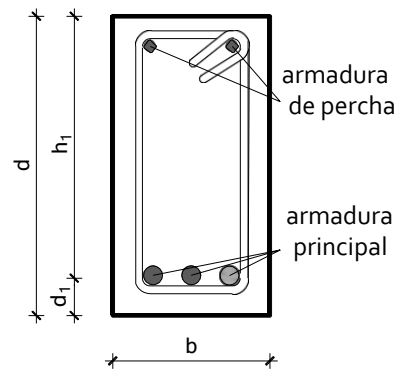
Sección de una viga de hormigón armado.
